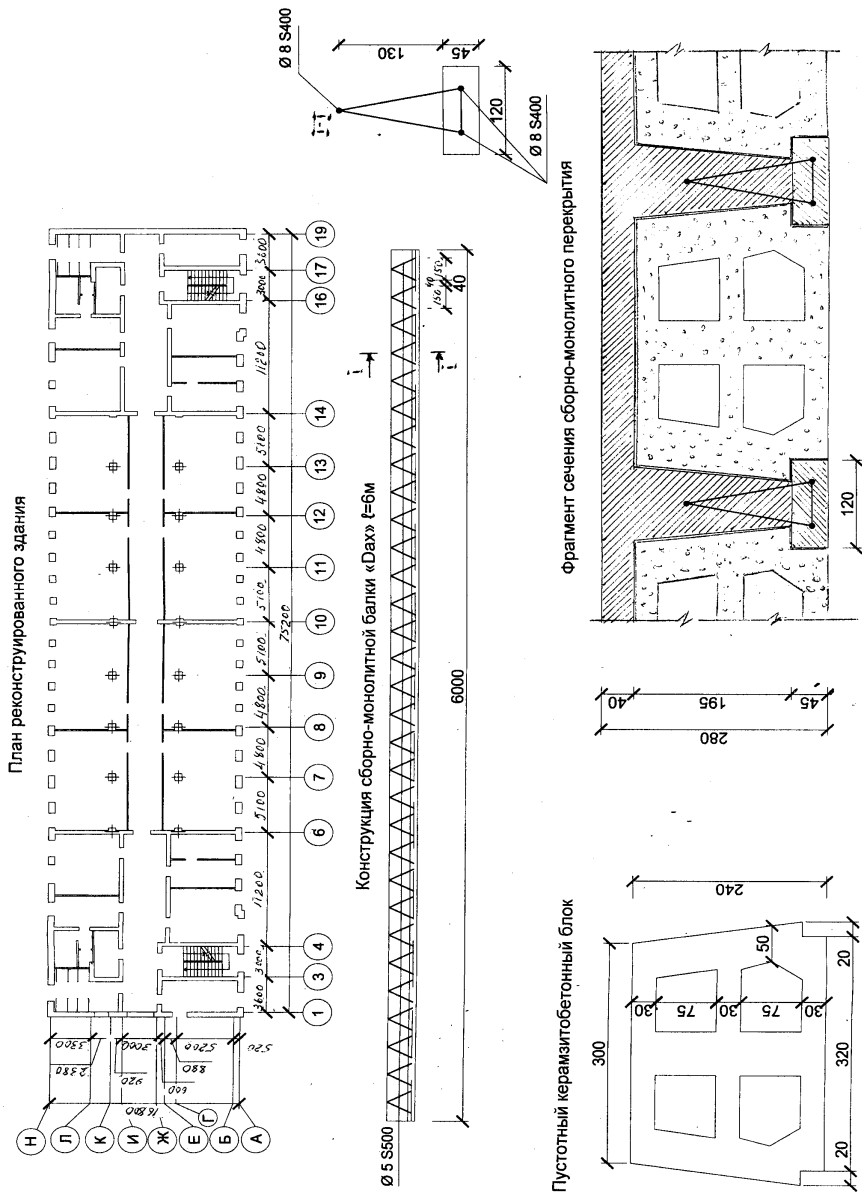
План реконструируемого здания и конструкция составляющих элементов сборно-монолитного перекрытия
